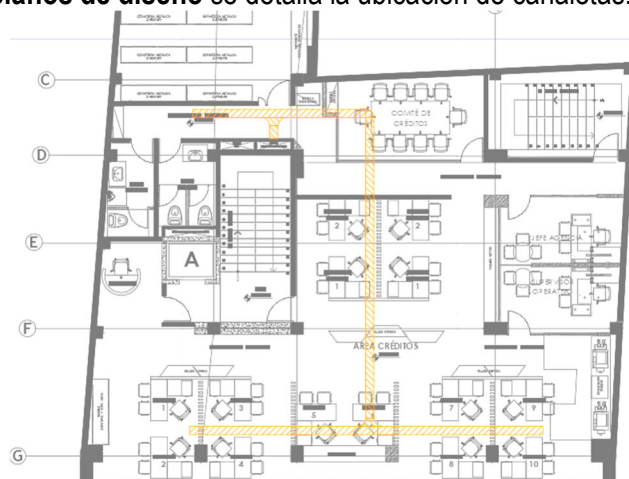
Detalle ejemplo de Distribución de Canaleta en Planta.
